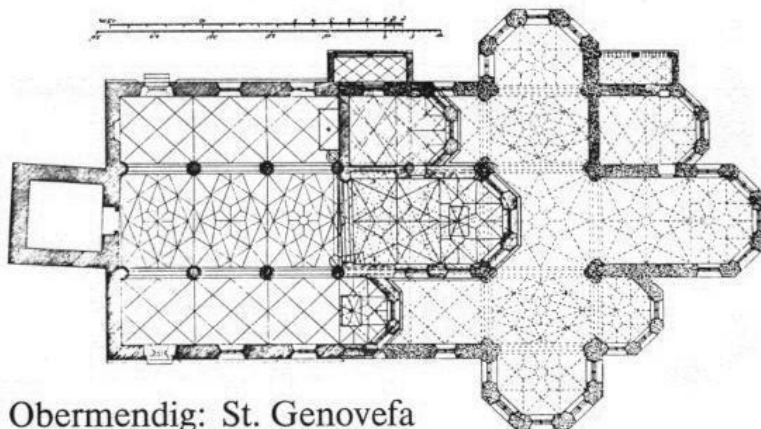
Obermendig, St. Genovefa, Grundriss
